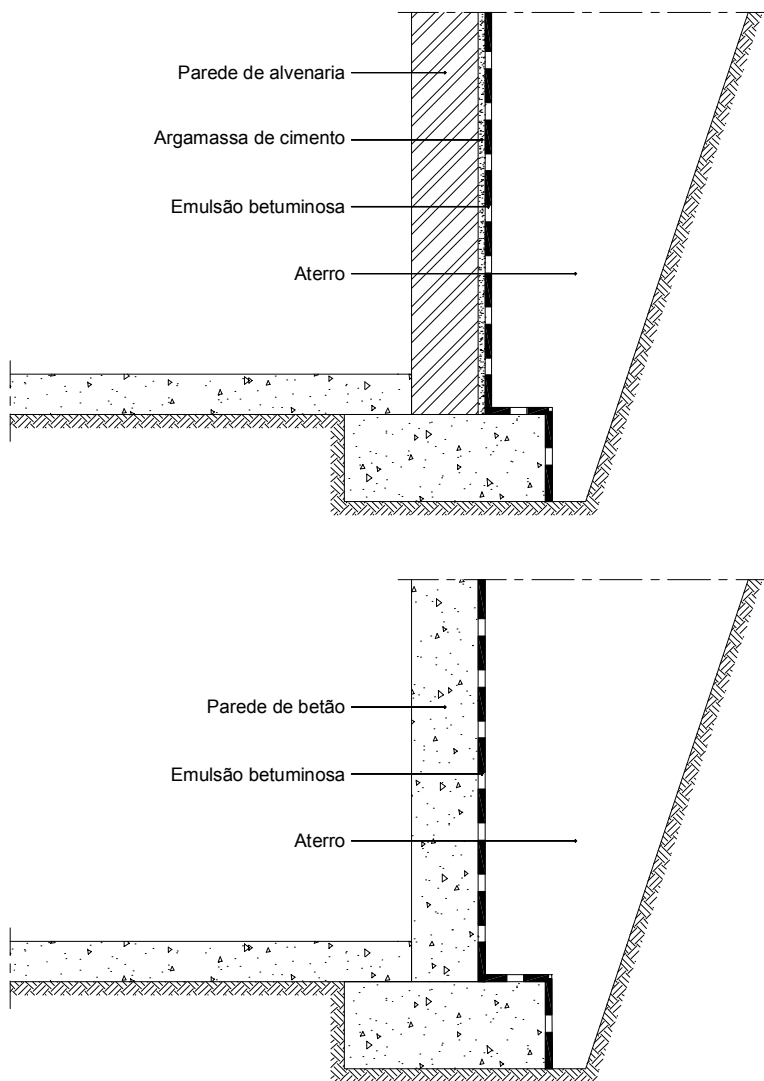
Impermeabilização de paredes enterradas com emulsões betuminosas
